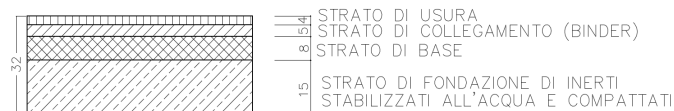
Particolare del pacchetto della sovrastruttura stradale
